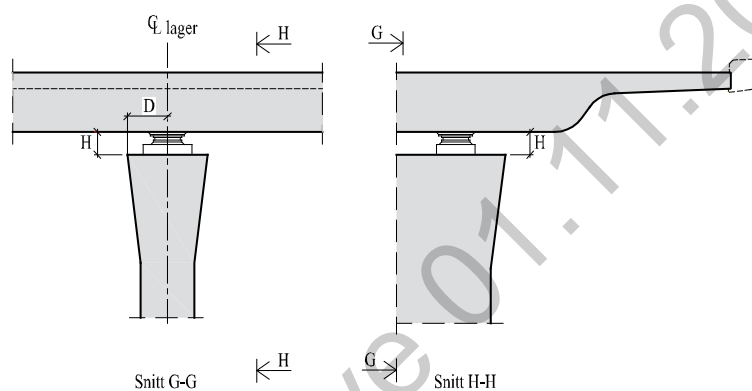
Krav til frihøyde ved lagre – 1-sidig tilkømt/fastlager
